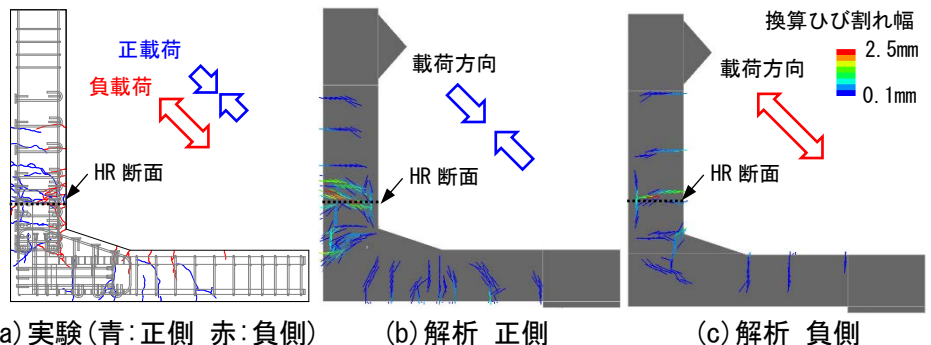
ひび割れ図(実験, 解析ともに 3δy 時点, 解析はひび割れひずみ)
